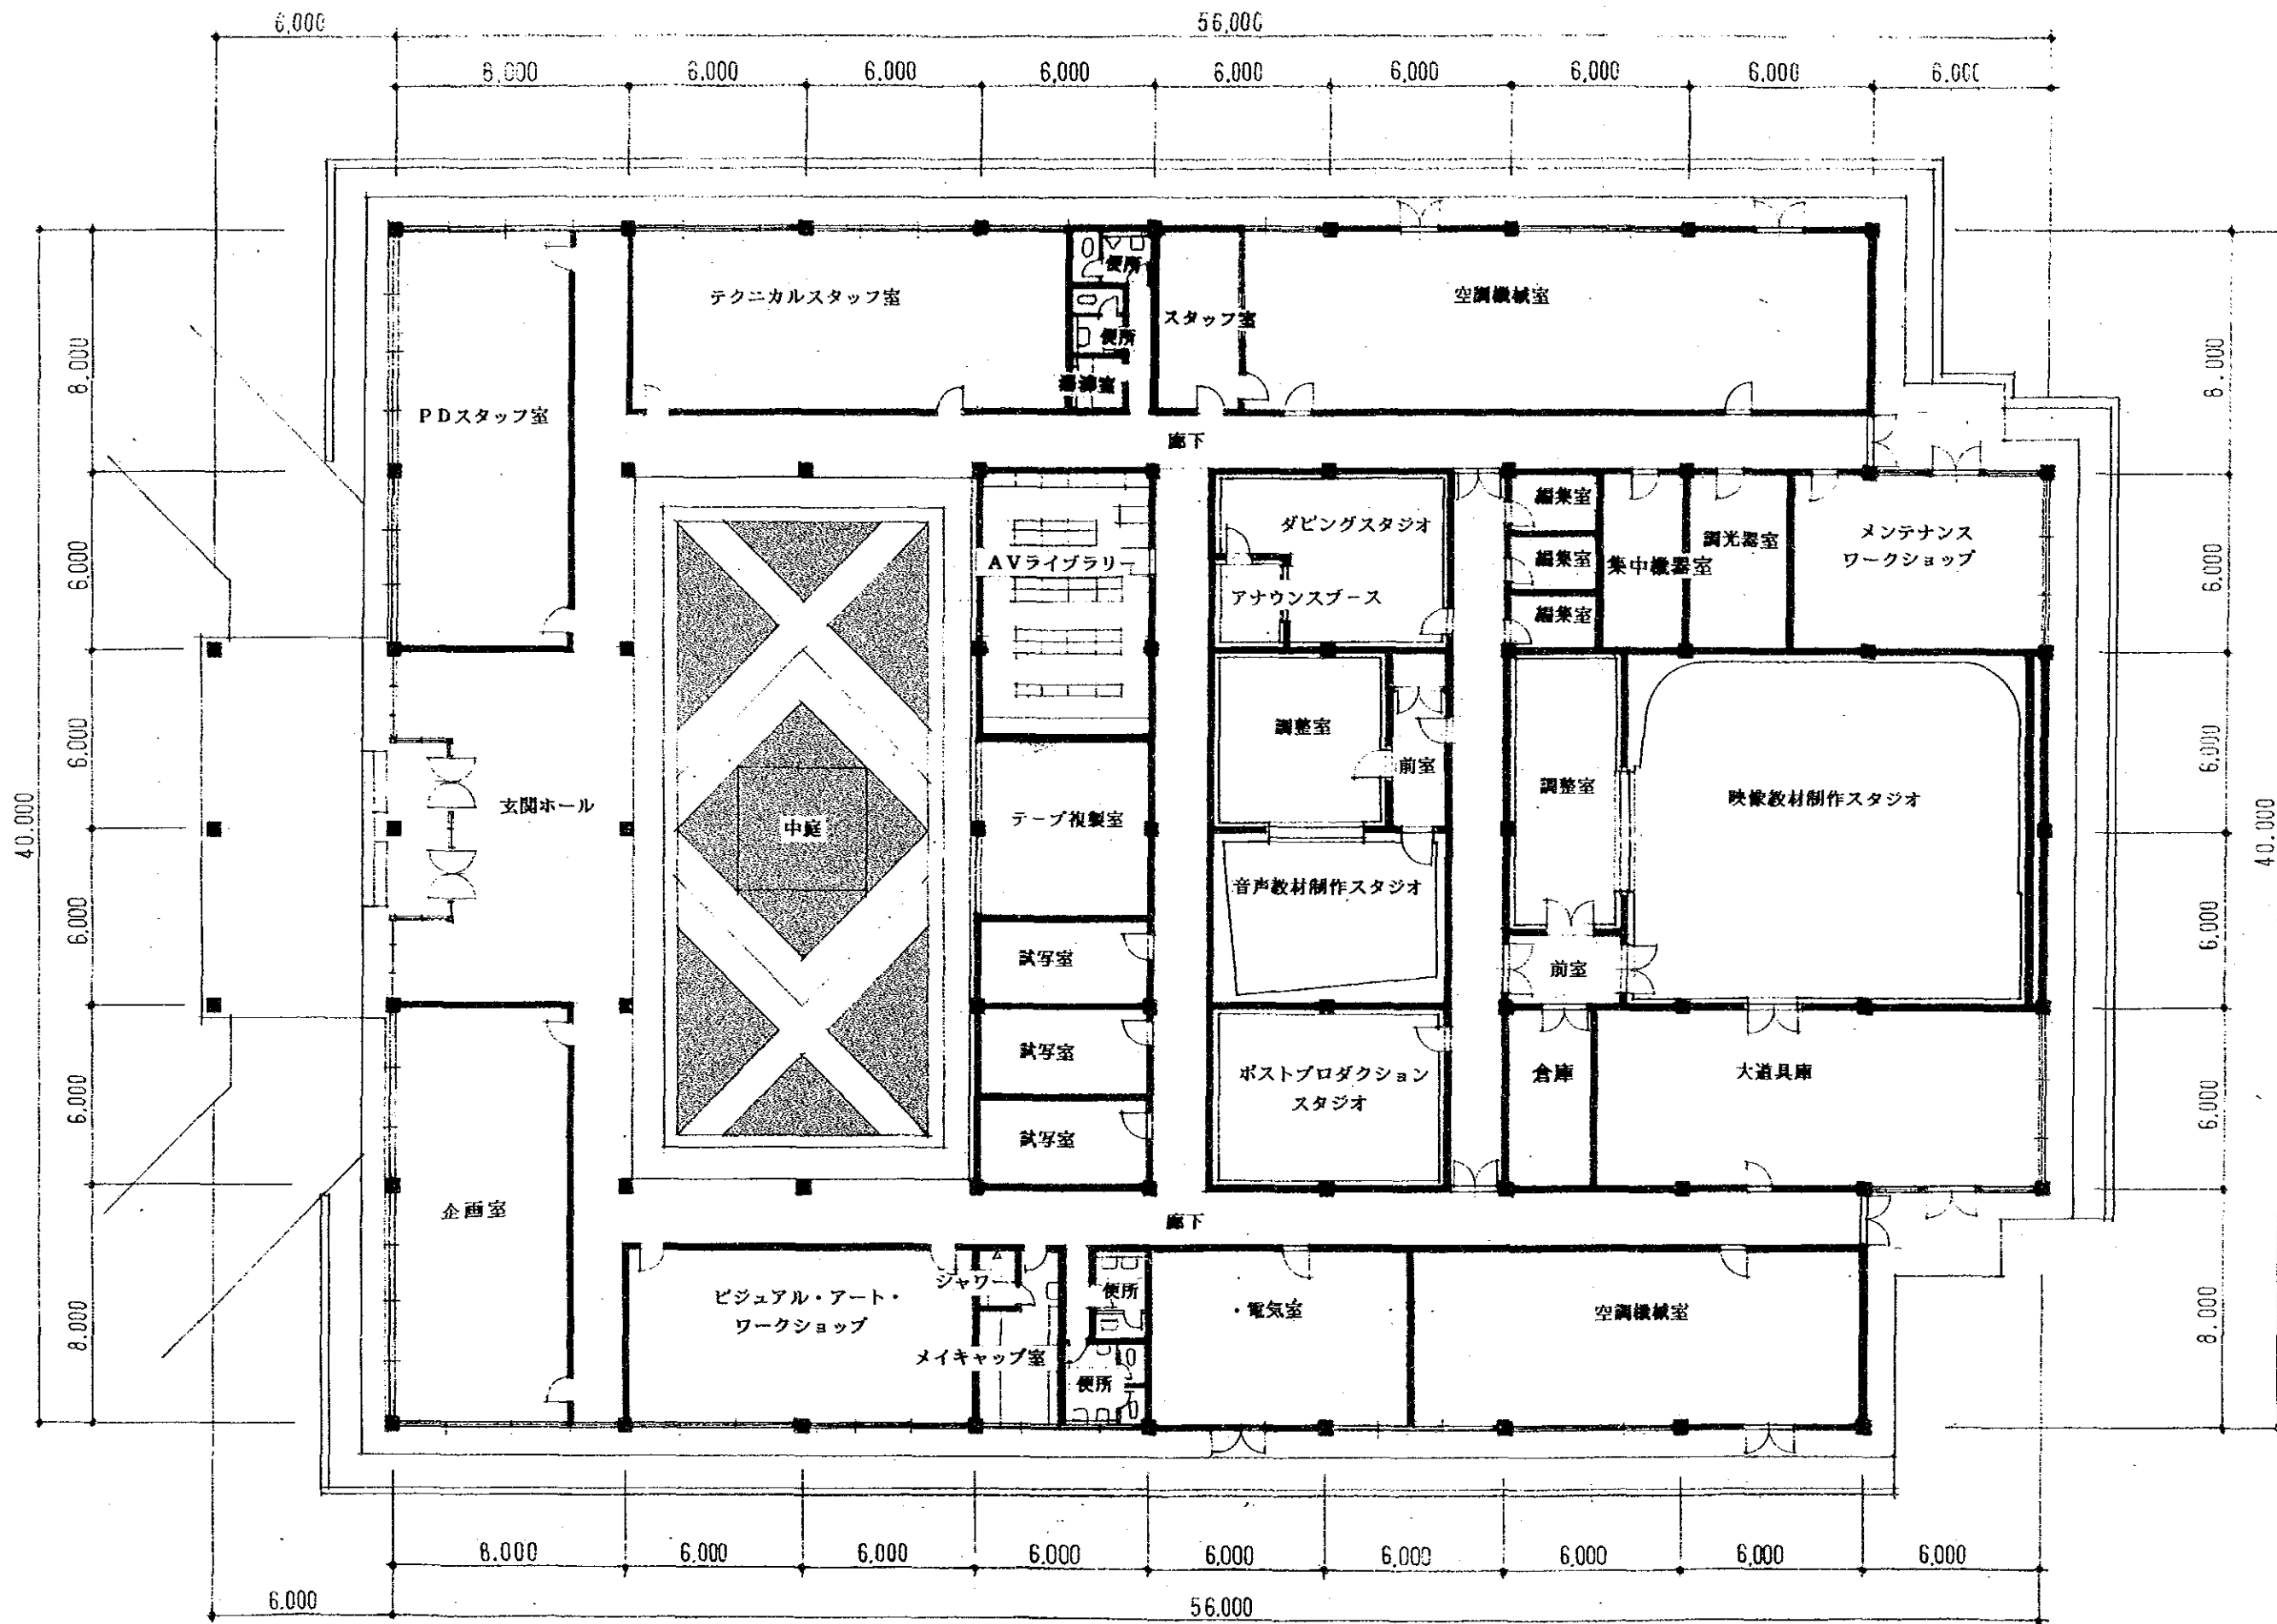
スリランカ公開大学AV教育センター平面図 1:200
